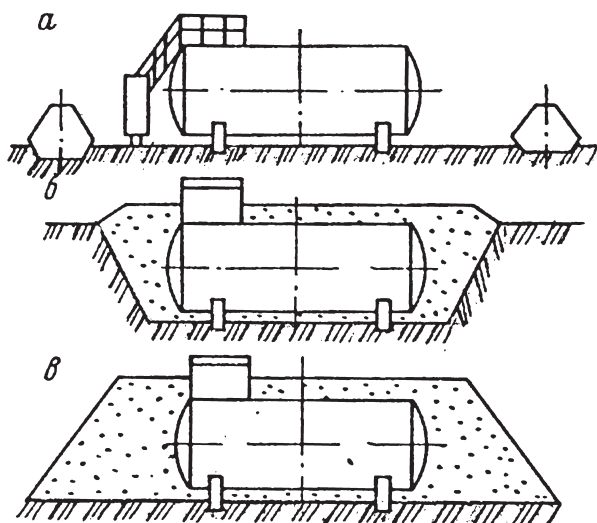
Схемы установки цилиндрических резервуаров:
